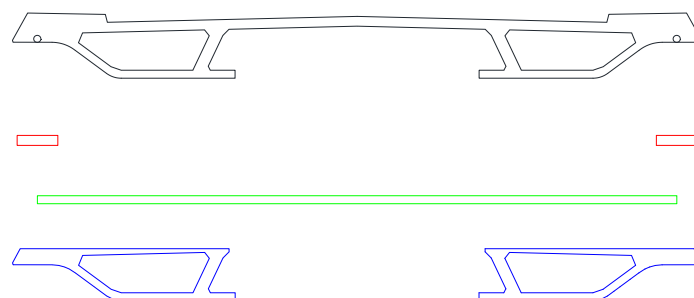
Seção principal do Tabuleiro da ponte sobre o Rio Arade (Preta), Vigas de bordo (Vermelho); Laje (Verde) e Viga principal (Azul).
